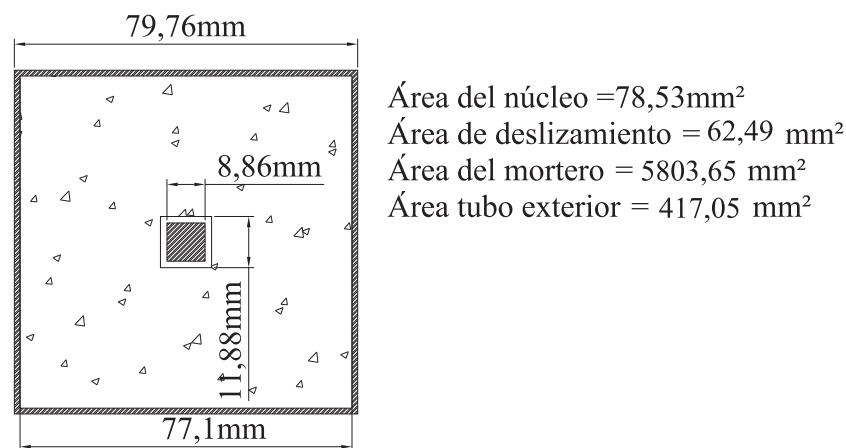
Sección transversal de las BPR D1 y D2 modificada para su modelación
